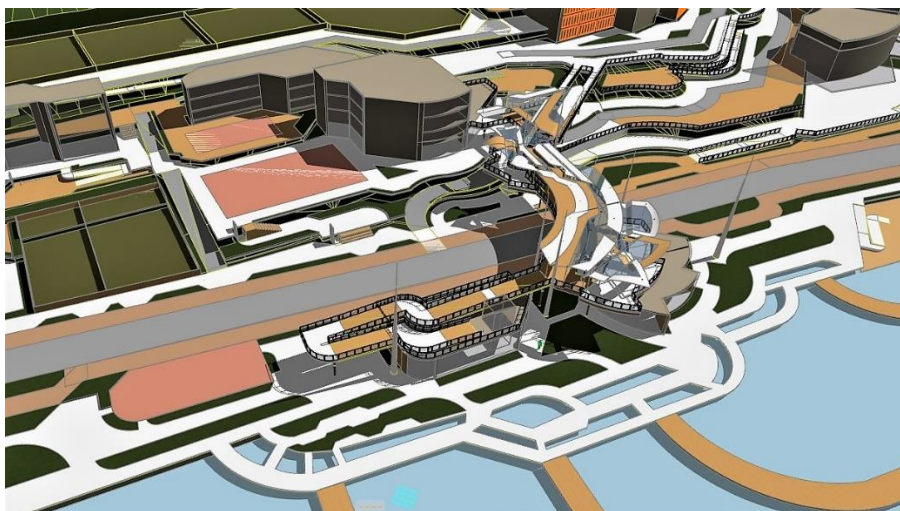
Зона образовательного учреждения с выходом на пешеходный мост с корпуса школы и спуском на набережную
